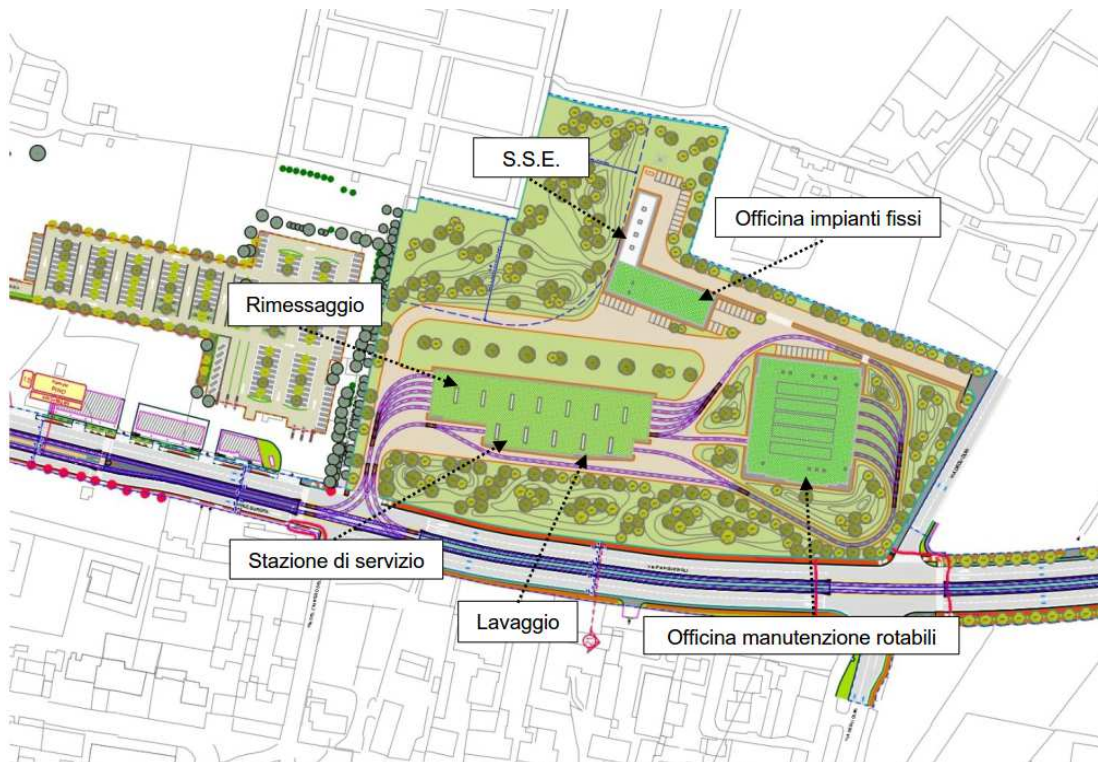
Layout Deposito/rimessaggio Bagno a Ripoli
